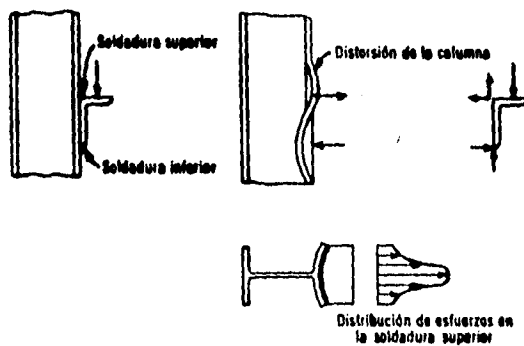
SOLDADURAS NO ACONSEJABLES ENTRE EL ASIENTO DE LA VIGA Y LA COLUMNA
